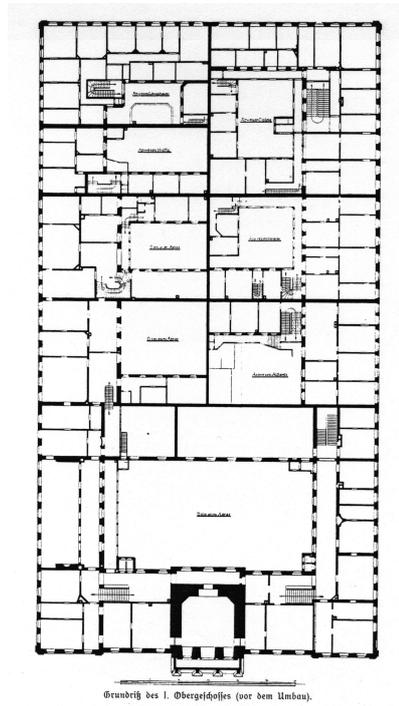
Grundriß des 1. Obergeschosses vor dem Umbau
